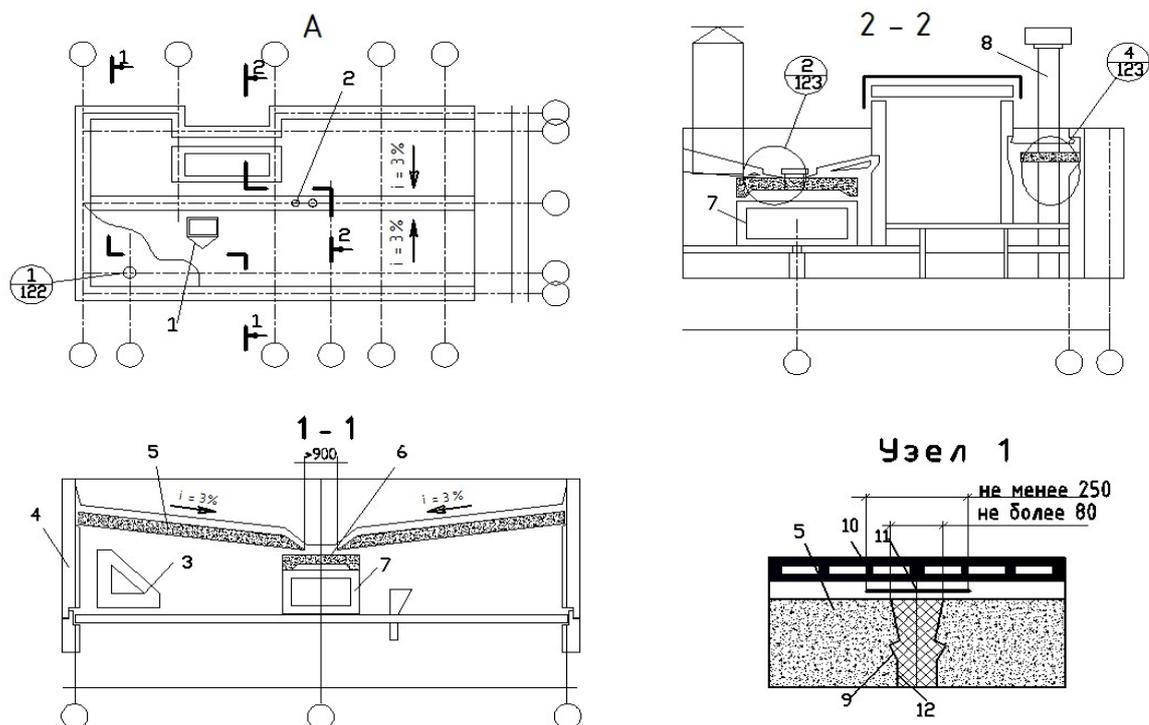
Рулонная крыша с теплым чердаком (тип В): А – схема-план крыши; 1 – вытяжная шахта; 2 – водосточная воронка; 3 – опорный элемент фризовой панели; 4 – фризová панель; 5 – кровельная панель; 6 – лотковая панель; 7 – опорная рама; 8 – вентиляционная труба; 9 – утепляющий вкладыш; 10 – основная кровля; 11 – скользящая полоса рулонного материала; 12 – цементно-песчаный раствор.
